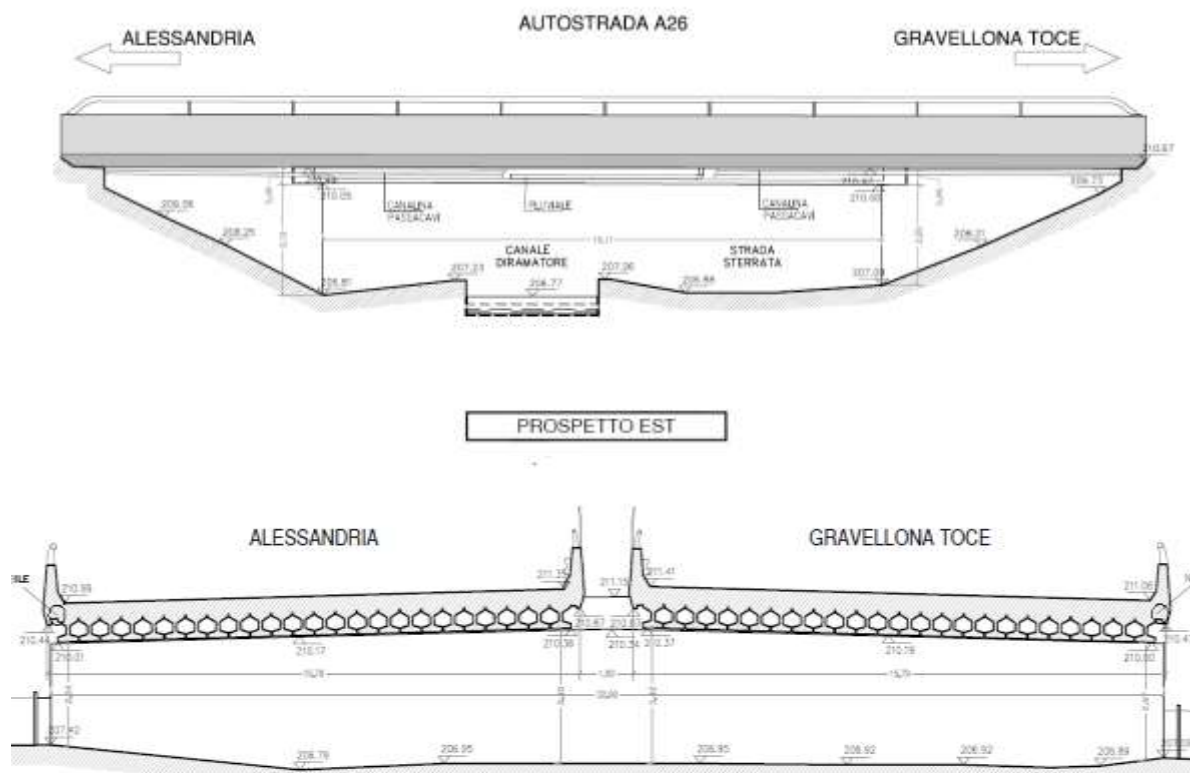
Esempio di restituzione – rilievo delle parti strutturali
